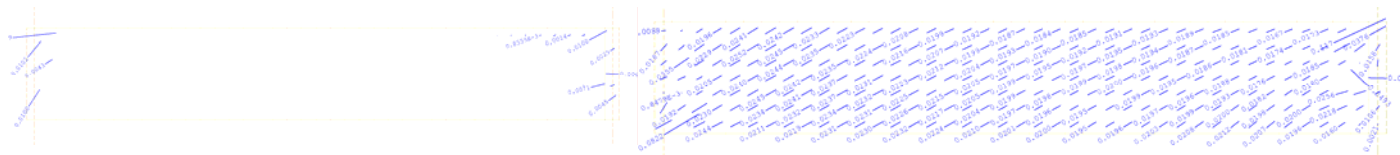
ステップ 1 (左) およびステップ 5(右)のウェブ側面のひび割れ図
